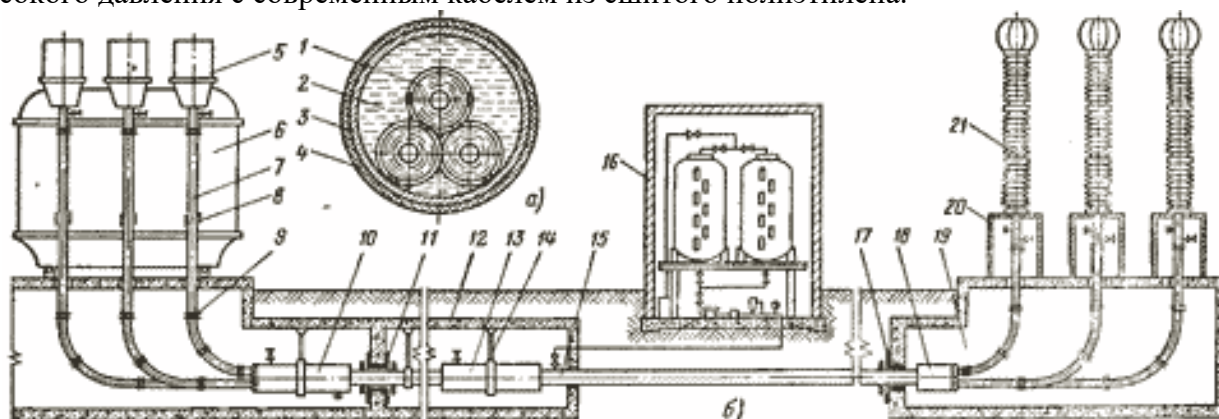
Поперечный разрез кабелей в стальном трубопроводе (а) и схема кабельной линии высокого давления (б):
